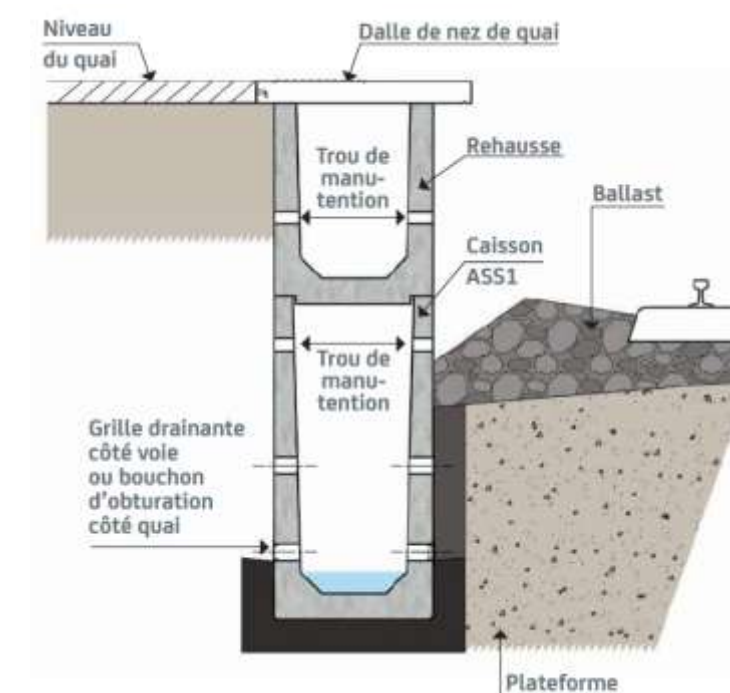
principe en coupe d'un quai drainant (source : Bonna Sabla)
